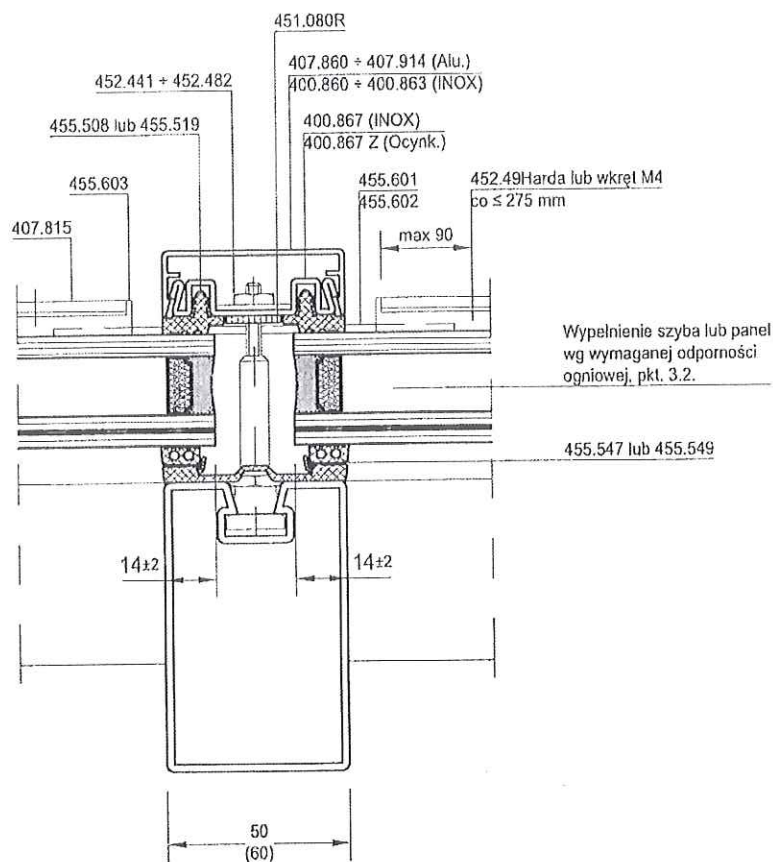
Przykładowe połączenie profili konstrukcyjnych systemu Jansen-VISS®
